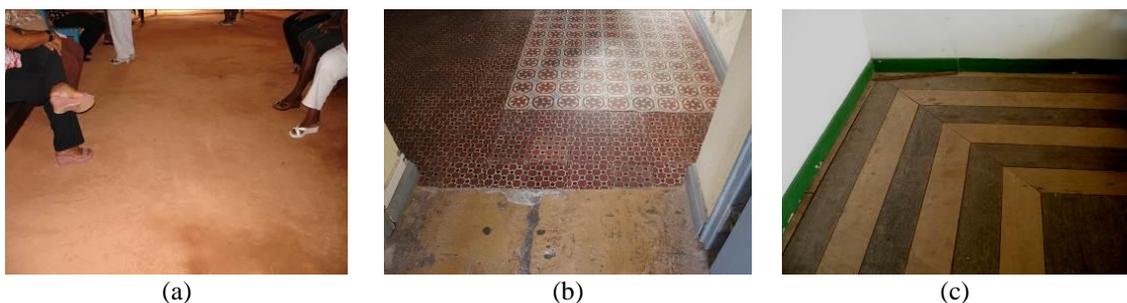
(a) Piso do tipo chão batido; (b) Soleira em pedra de lioz e piso em ladrilho hidráulico; (c) Piso em assoalho, em dois tons de madeira. Fotos Margareth Figueiredo.
